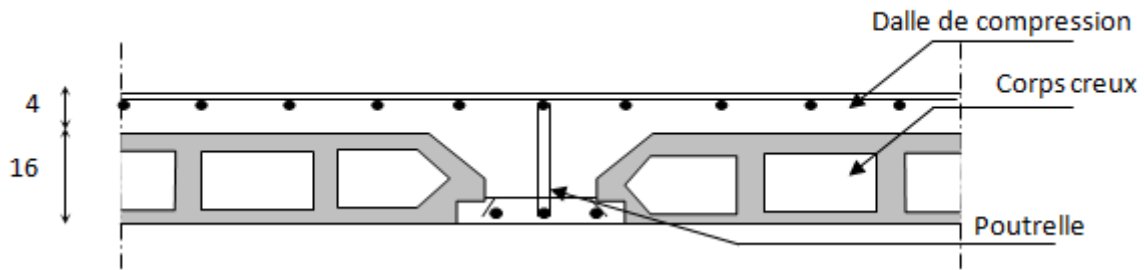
schéma descriptif d'un plancher à corps creux.
